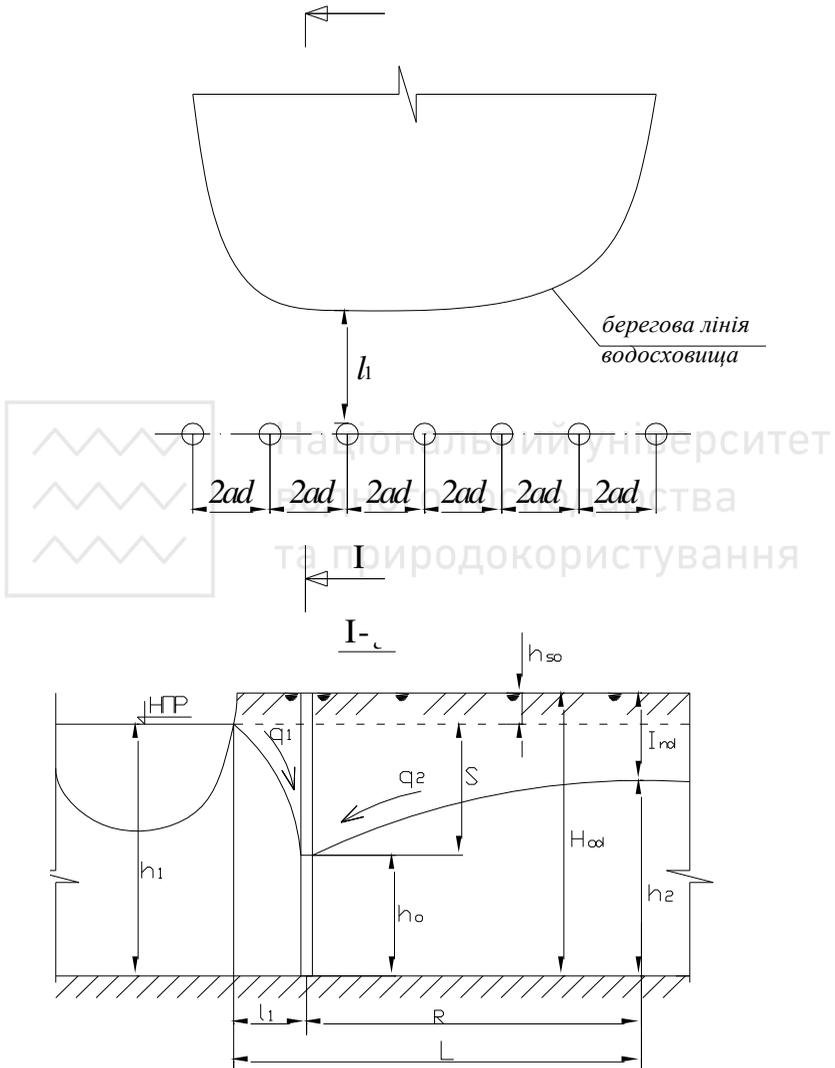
Розрахункова схема берегового вертикального дренажу
